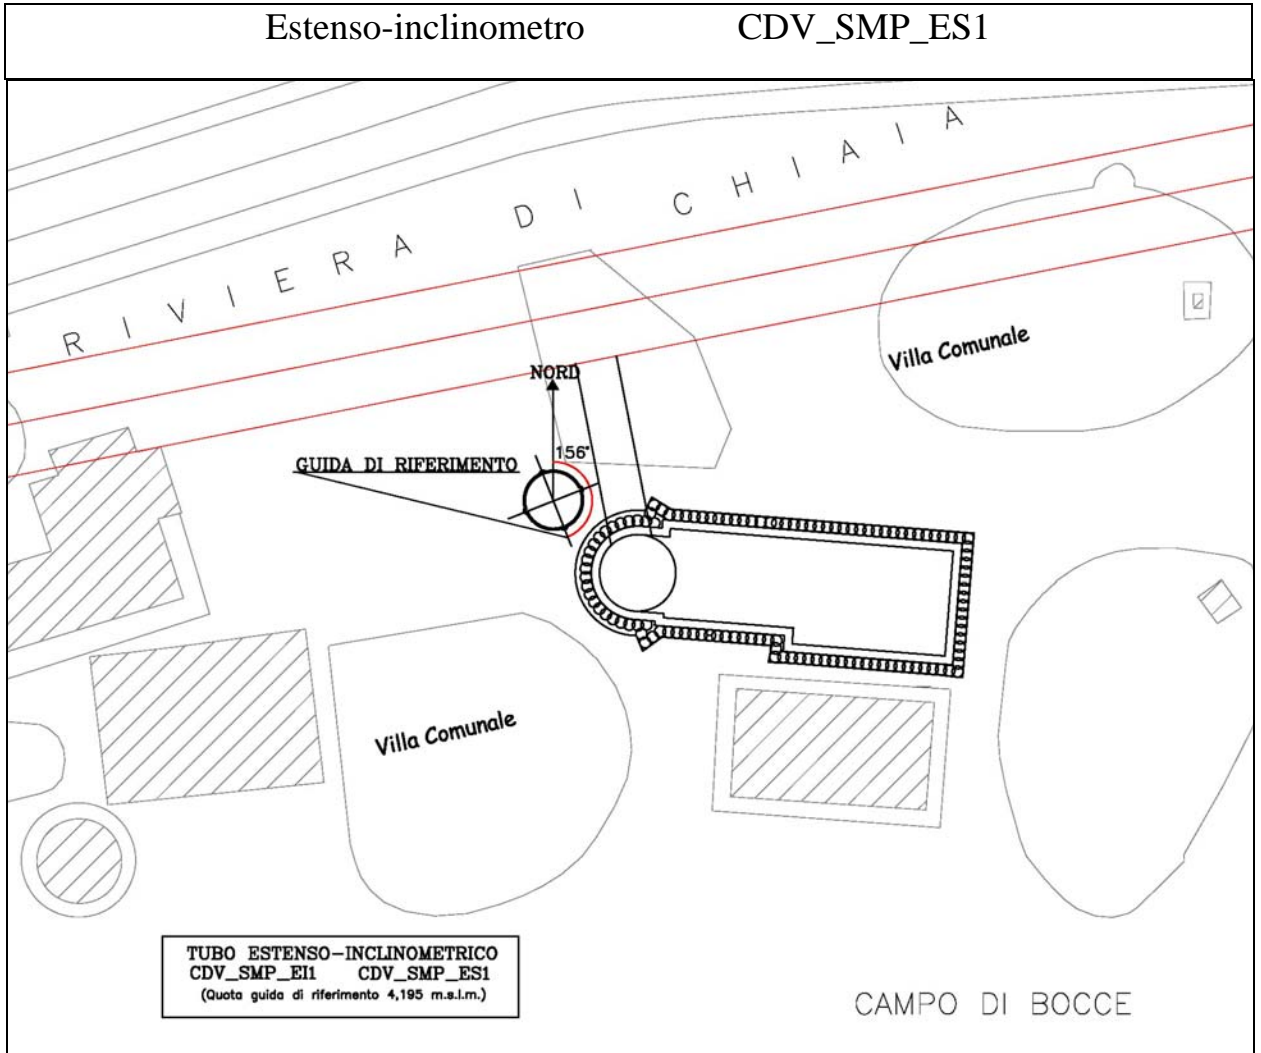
Planimetria Camera di Ventilazione “S.MARIA IN PORTICO”, raffigurante la disposizione della strumentazione di monitoraggio.
